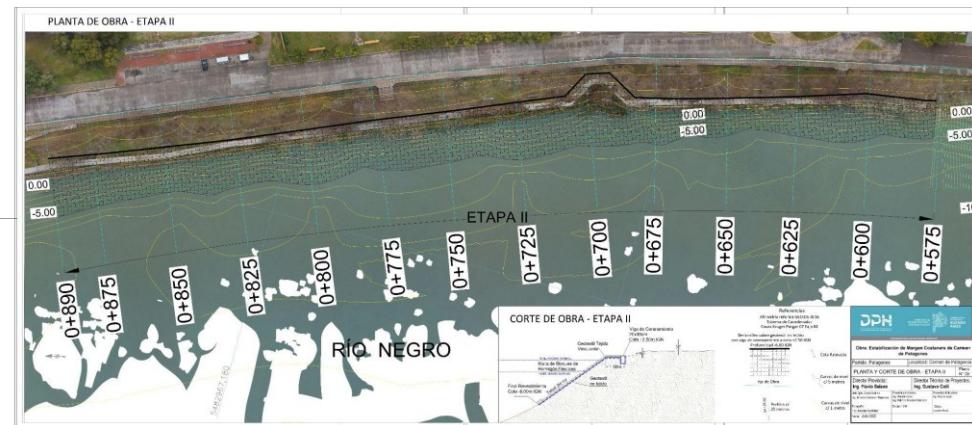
Planta de obra de Etapa 2. Fuente: DPH (2025).
